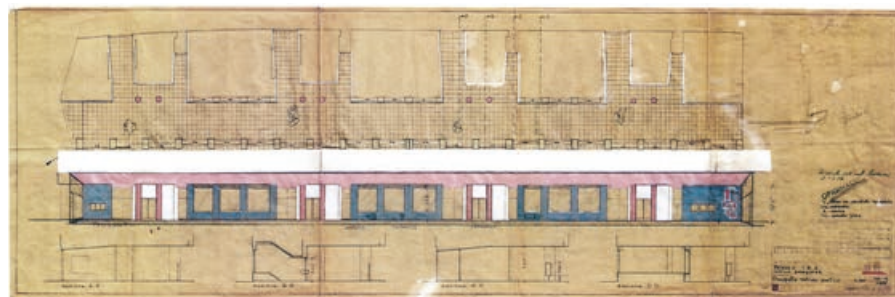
Pianta e alzato del portico, studio dei colori, dicembre 1955. Archivio Piero Bottoni, DASTu, PoliMi. Pianta del progetto costruito (*Casa Milanesi 1923-1973*)
